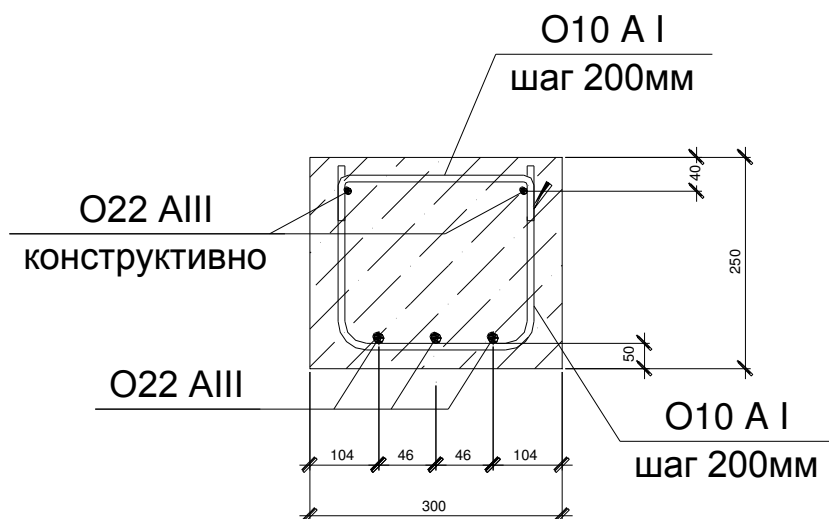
Схема армирования ригеля в середине пролета
